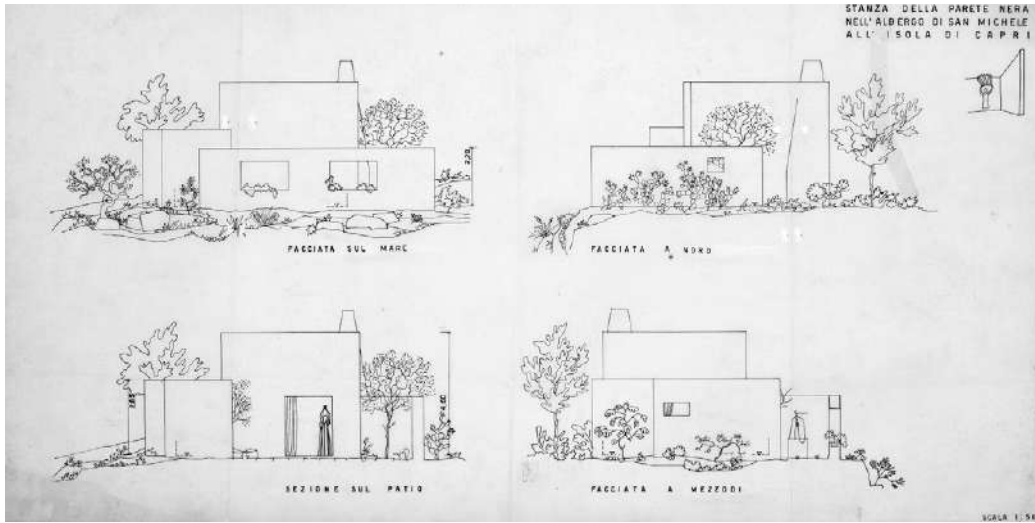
Stanza della parete nera: prospetti e sezione sul patio (CSAC, Università di Parma).
